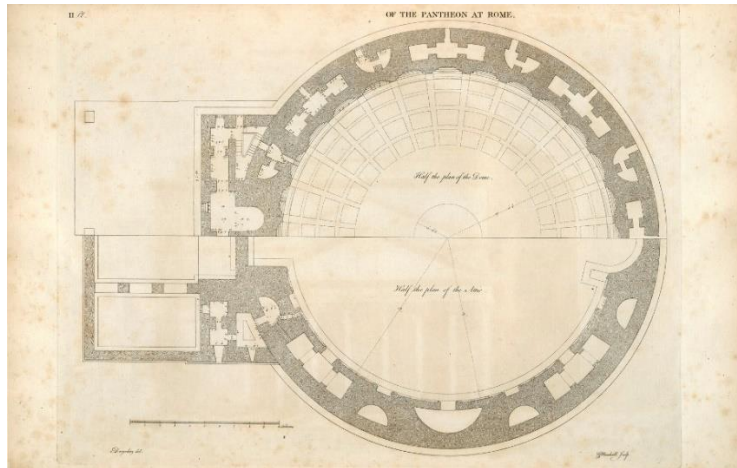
Planta da parte superior e planta refletida com a superfície interna
